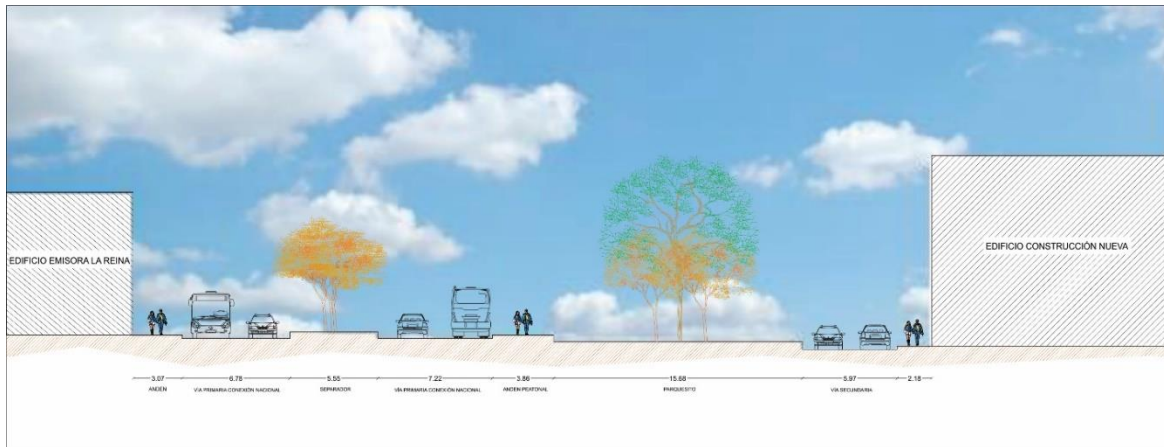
Perfil vial. Fuente: Elaboración Propia
